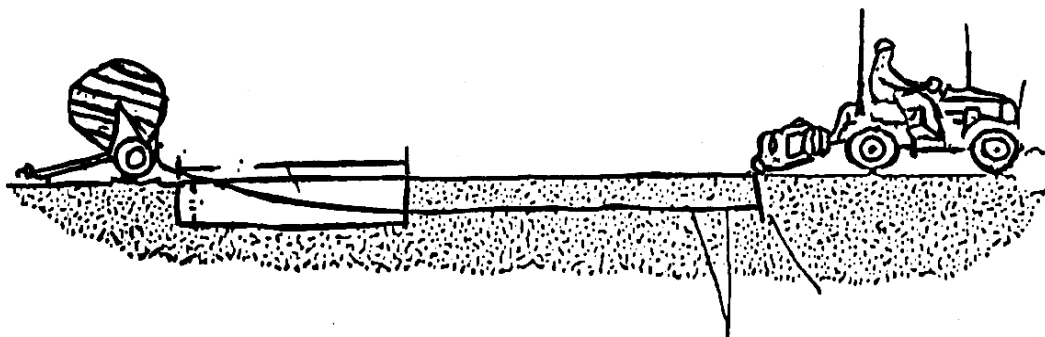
Instalação de cabo óptico encapsulado utilizando o método “Plow Pull”.
